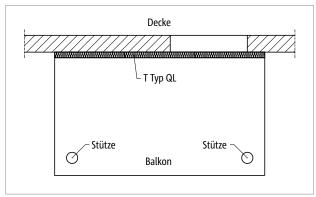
Schöck Isokorb® T Typ QL: Balkon mit Stützenlagerung
